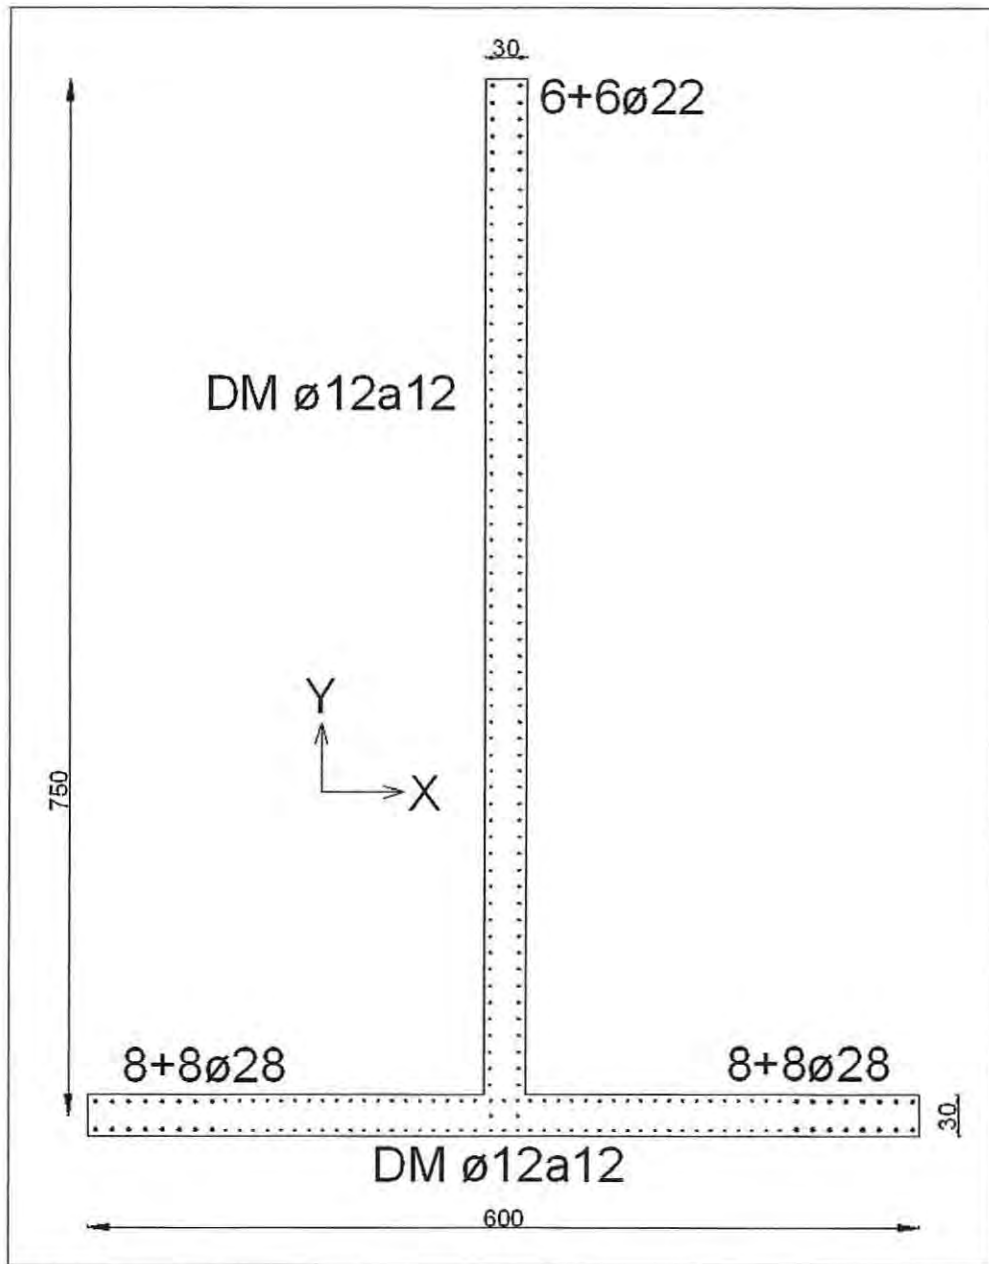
Distribución de la armadura longitudinal en alas y alma del muro.
